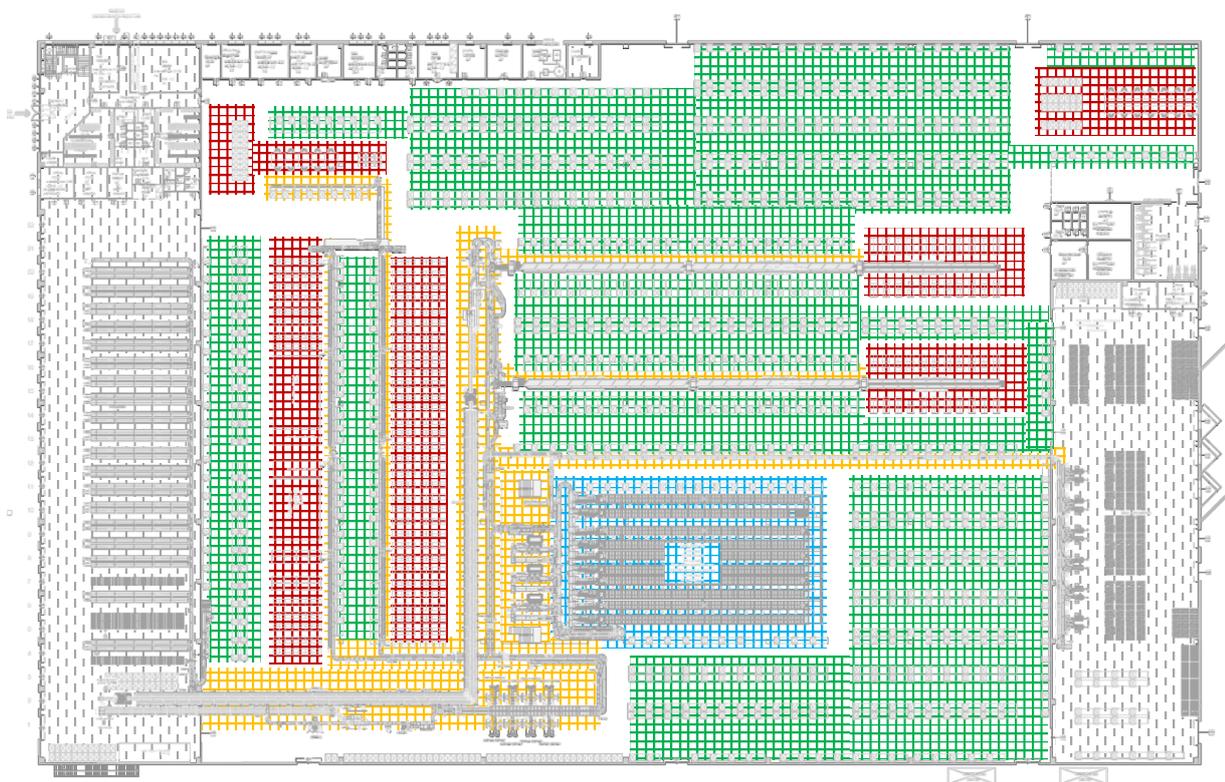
Planimetria piano terra *Compartimento 1 "Magazzino"*: individuazione aree innesco
